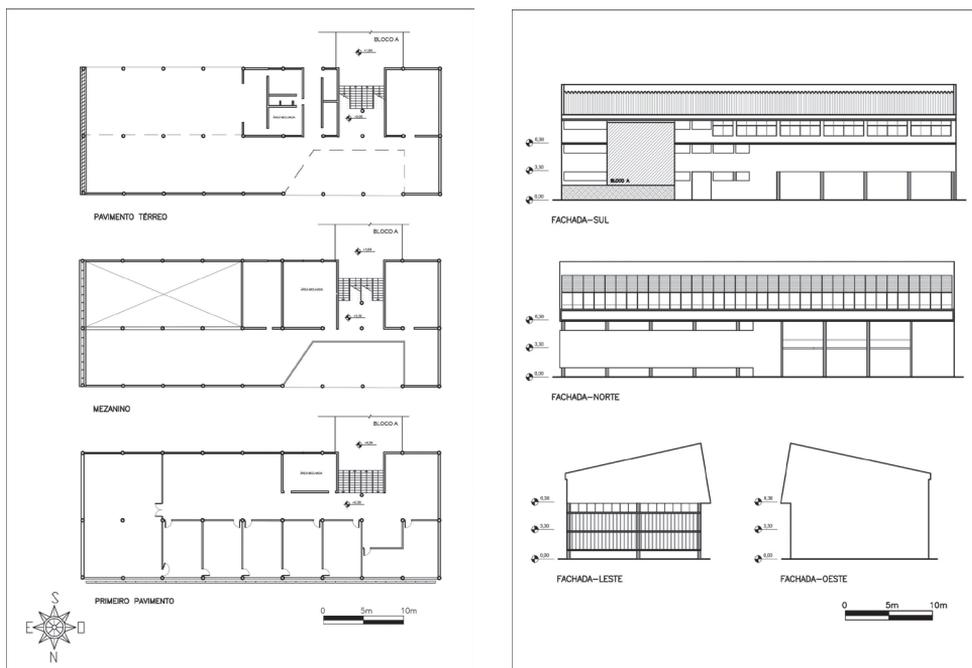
Planta e Elevação Escola Politécnica do Espírito Santo
